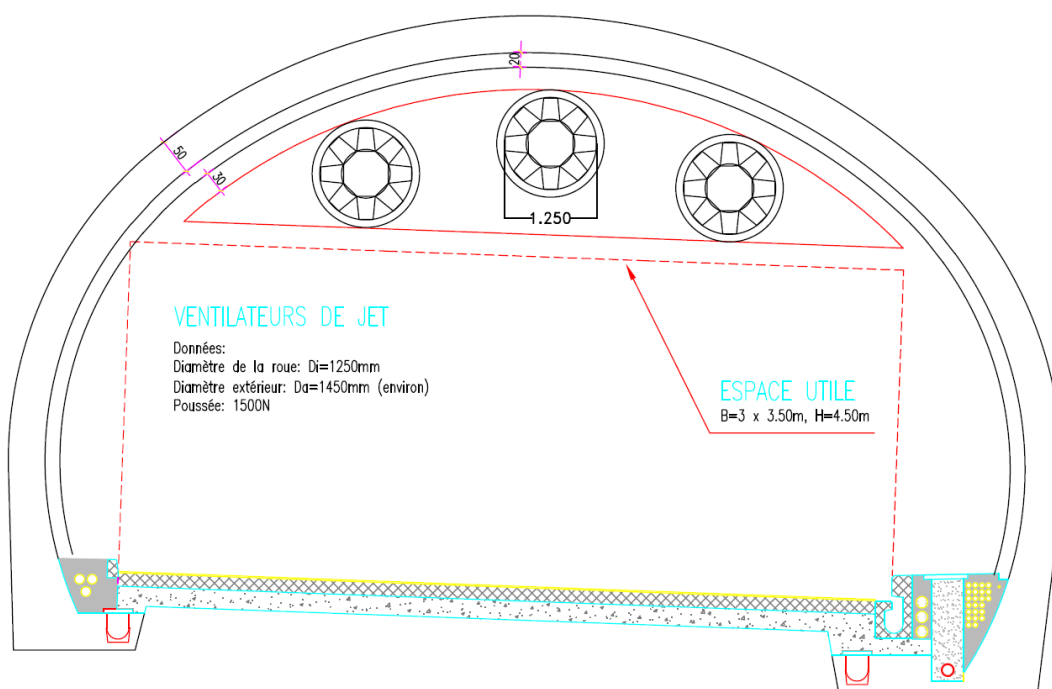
Coupe type du tunnel avec une batterie de 3 ventilateurs de jet de diamètre 1250 mm (hypothèse : 200 mm de revanche pour étanchéité du tunnel).
